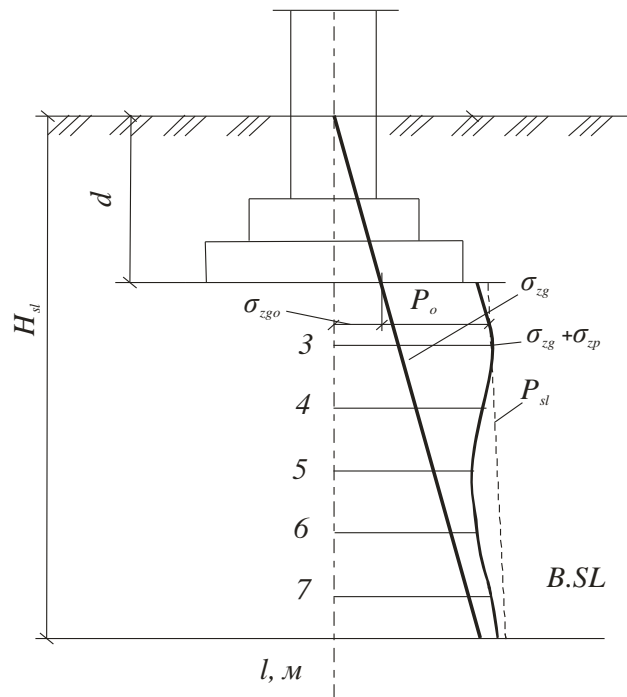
Схема распределения напряжений от собственного веса грунта σ_{zg} , дополнительного напряжения σ_{zp} и начального просадочного давления P_{sl} по глубине в основании фундамента
